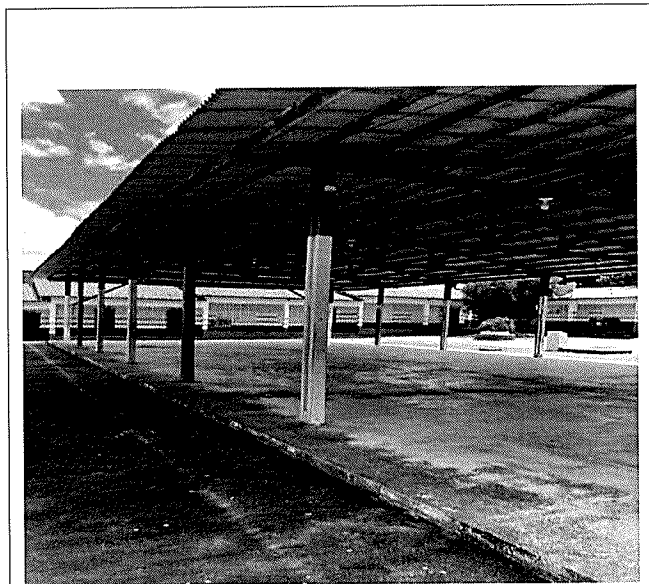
ÁREA EXTERNA COBERTA PAVILHÃO
